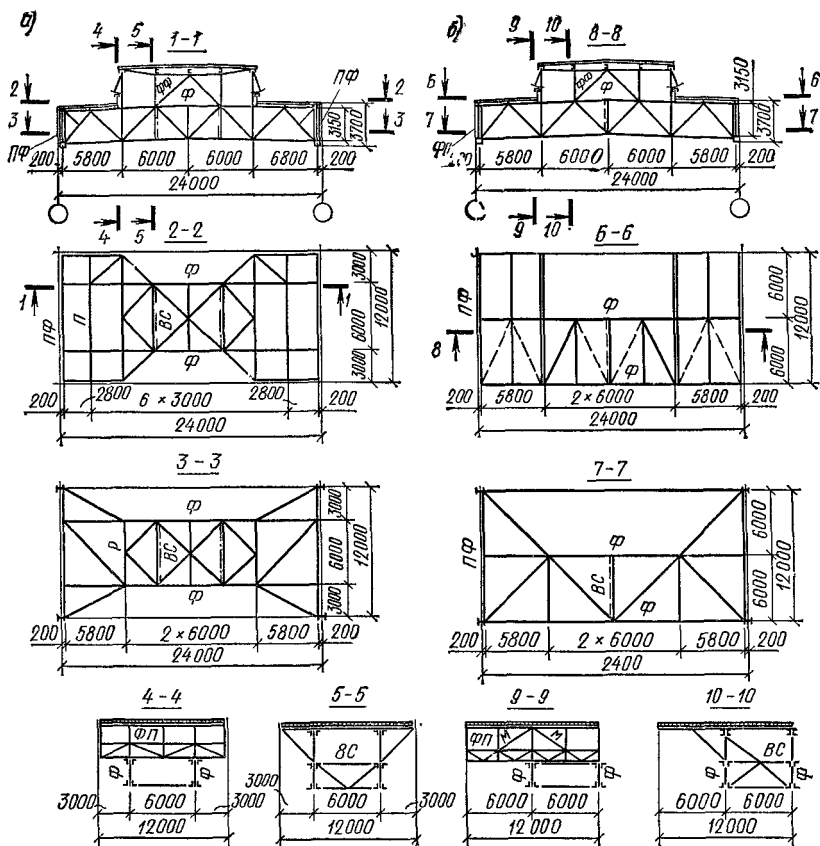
Стальные конструкции одноэтажных производственных зданий для условий конвейерной сборки и блочного монтажа
